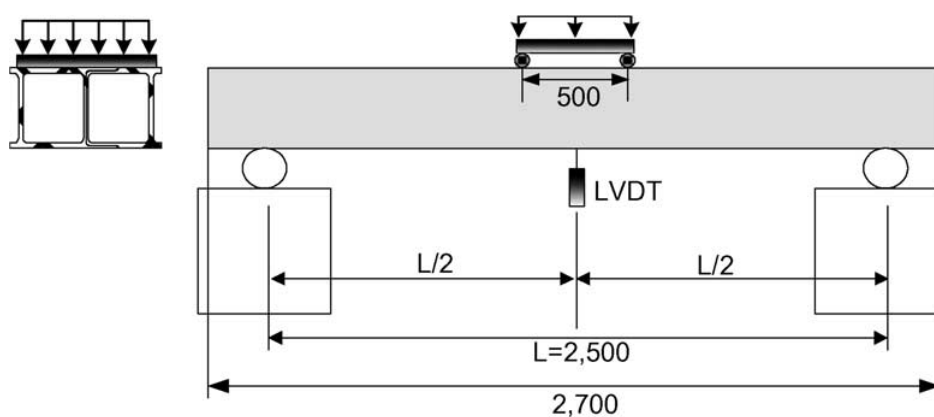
Posicionamento dos elementos de laje para ensaios de flexão pura
